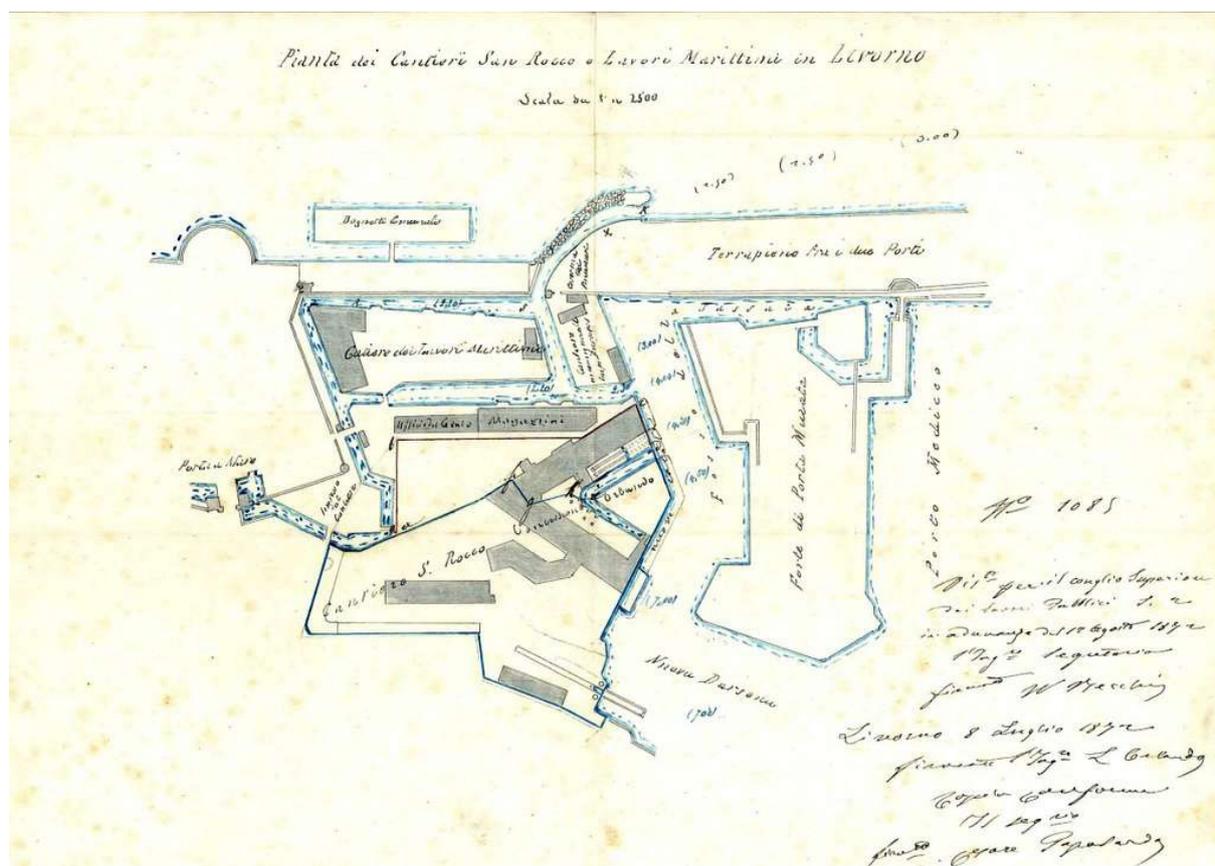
“Planimetria del Cantiere navale Fratelli Orlando comprendente i Cantieri San Rocco e Lavori Marittimi”, in *Archivio storico del Cantiere navale Luigi Orlando di Livorno*, 1872.
